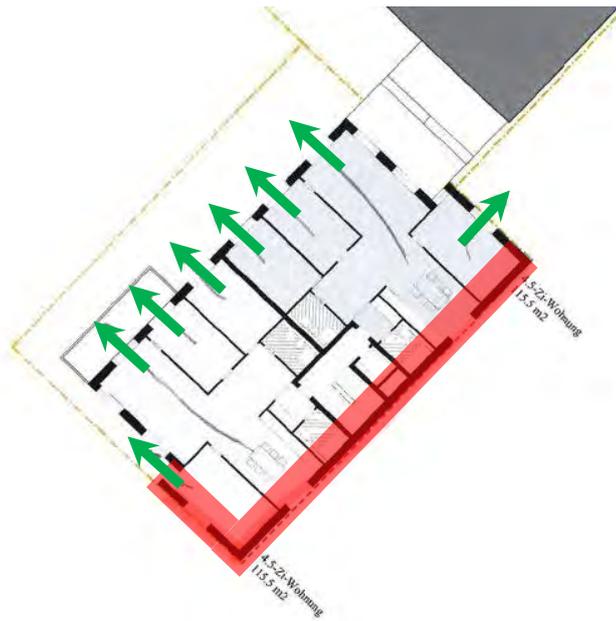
Regelgeschoss B2; rote Bereiche: IGW-Überschreitungen an Fassade
